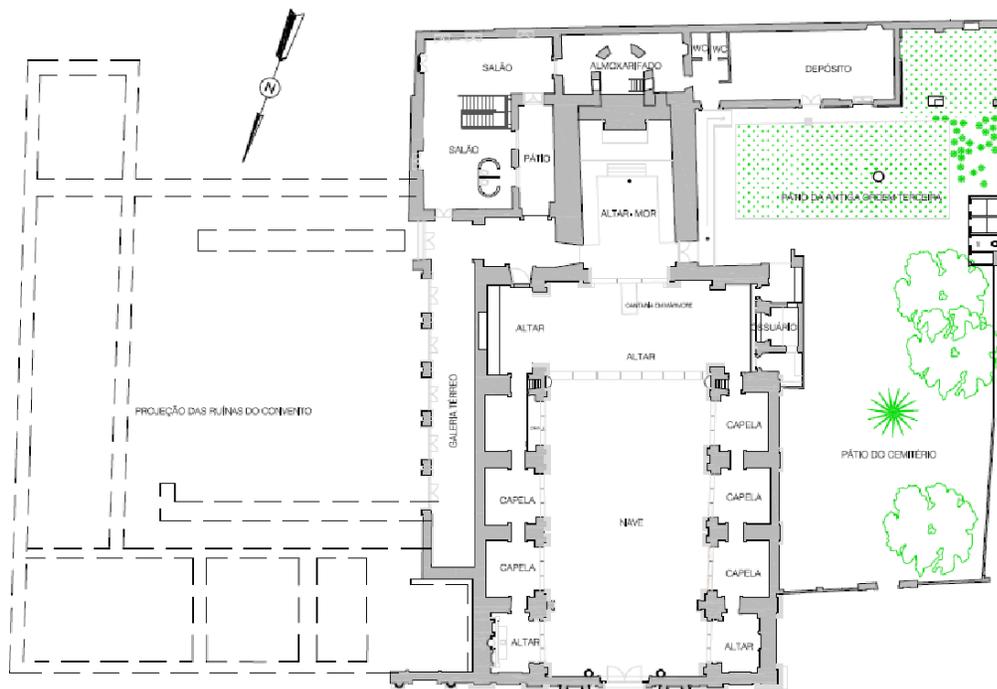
Planta Baixa do Pavimento Térreo da Igreja Nossa Senhora do Carmo. Fonte: IPHAN (adaptado).
